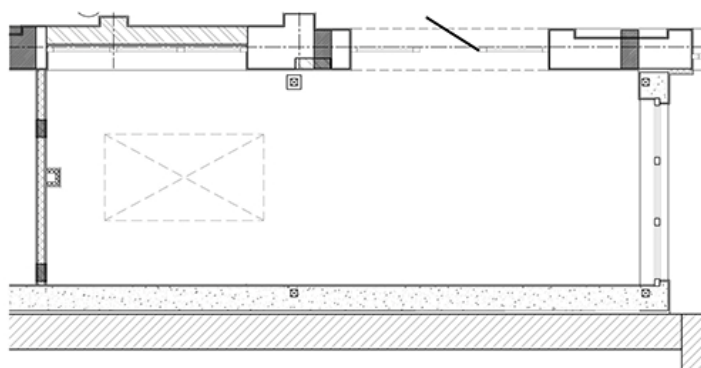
План помещения с прямоугольной формой фонаря верхнего освещения
